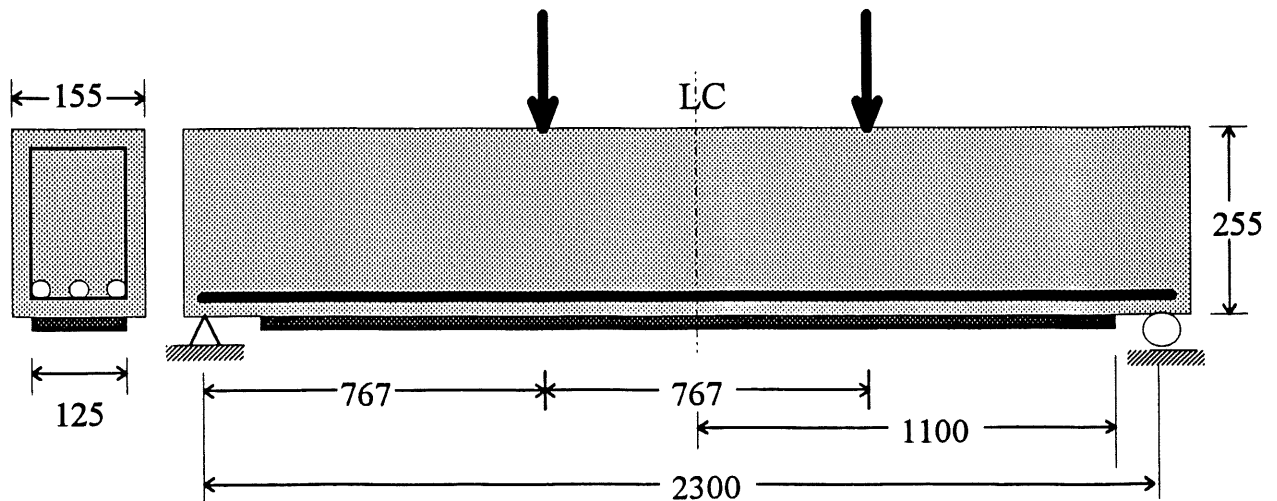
Poutre en béton armé renforcée à l'aide d'une plaque d'acier
